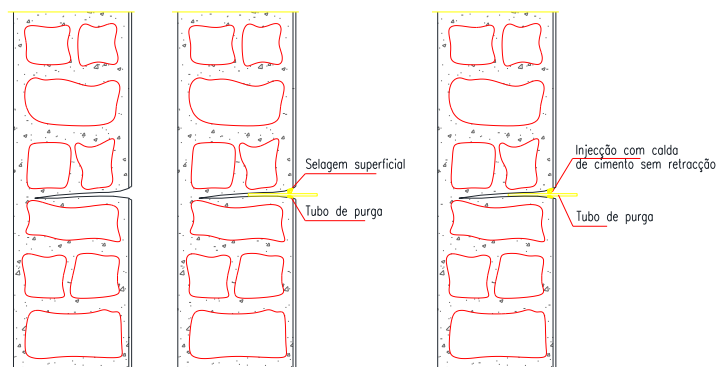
Pormenores de reforço das paredes de alvenaria nas zonas onde existe a necessidade de reparação de fendas em paredes e tectos.
